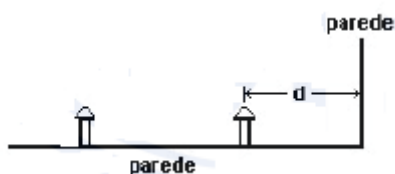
Distância (d) do chuveiro automático à parede (vista em planta)
